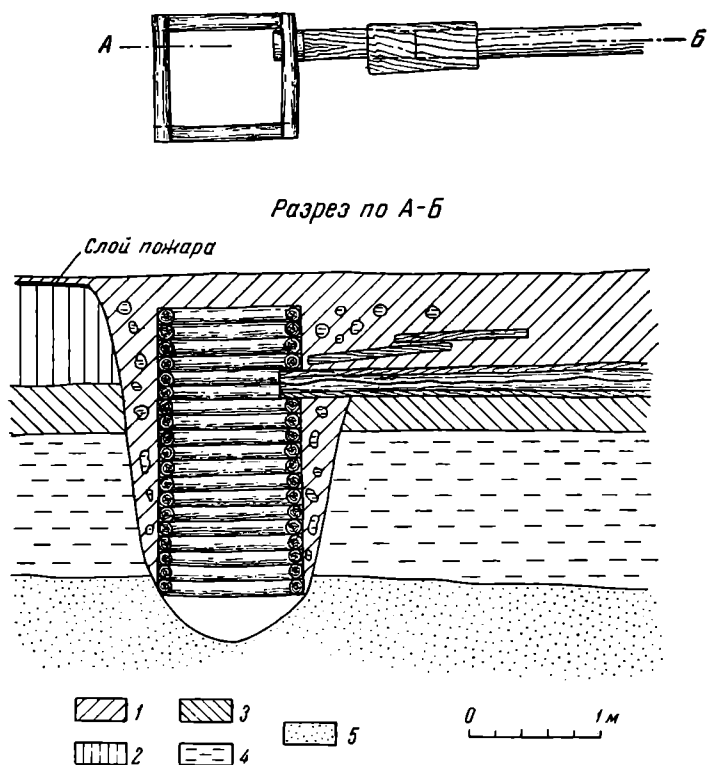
План и разрез дренажного колодца с деревянной трубой:
